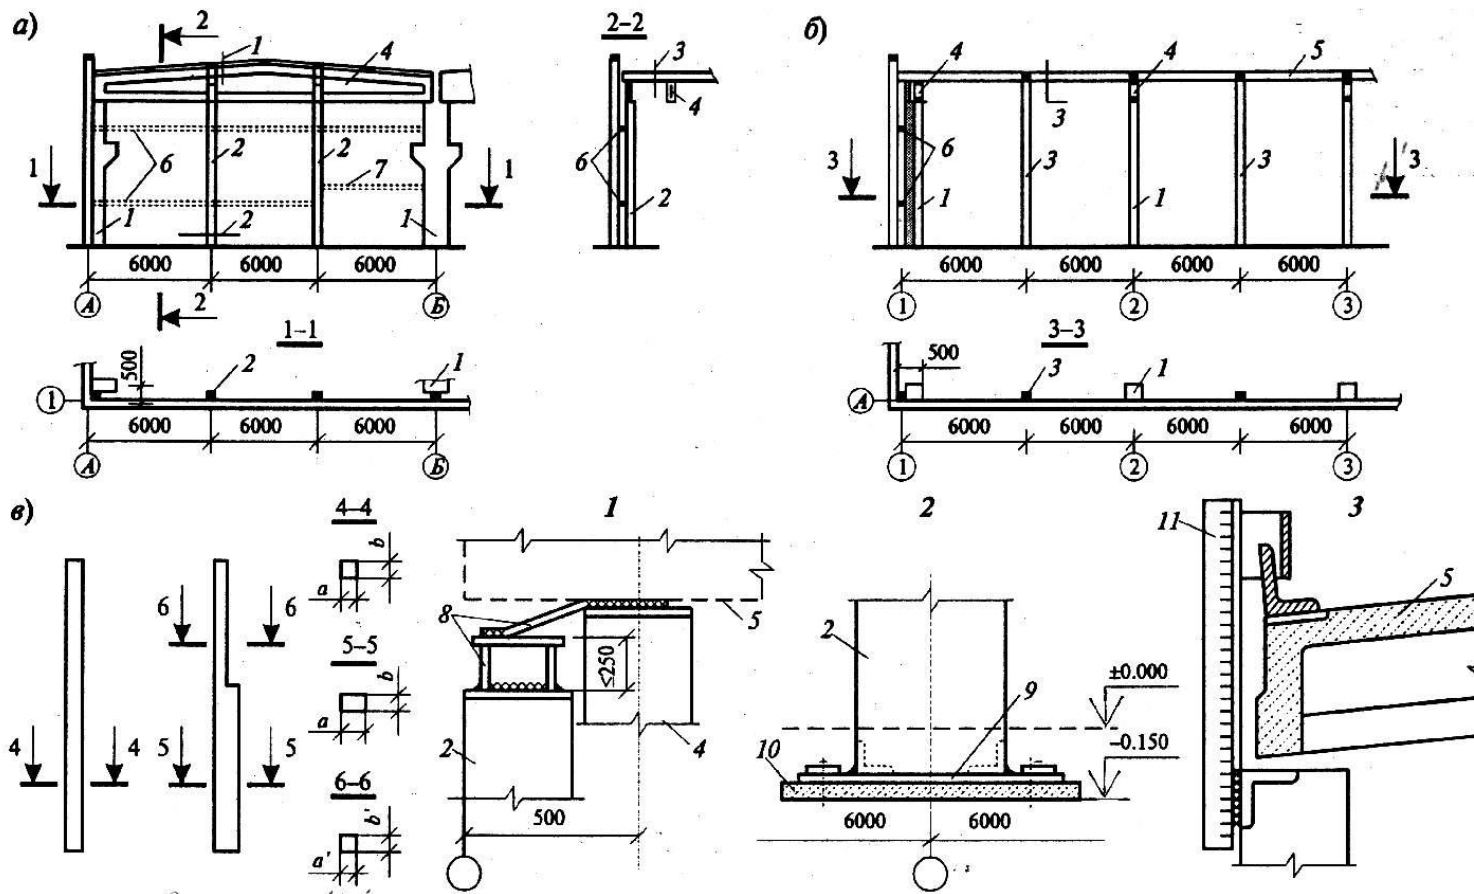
Фахверк при железобетонных каркасах:
